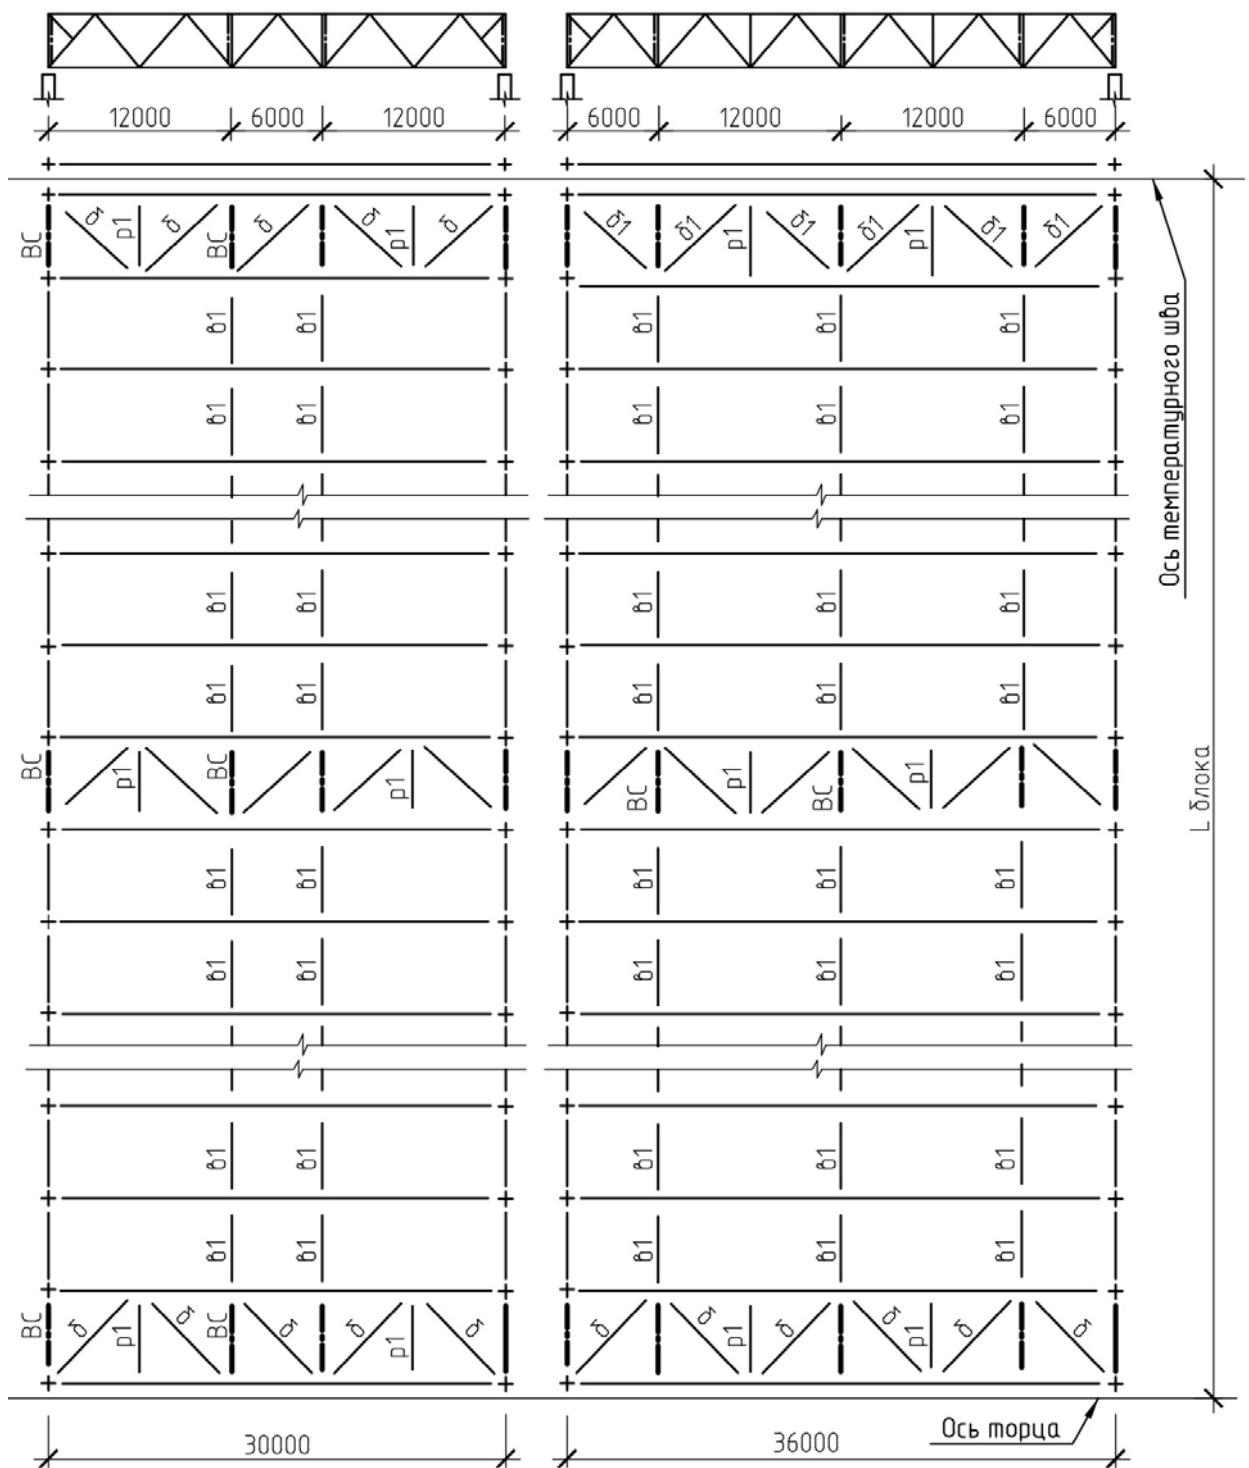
Схемы расположения связей II типа по нижним поясам стропильных ферм, шаг ферм 6 м, пролеты 30 и 36 метров
